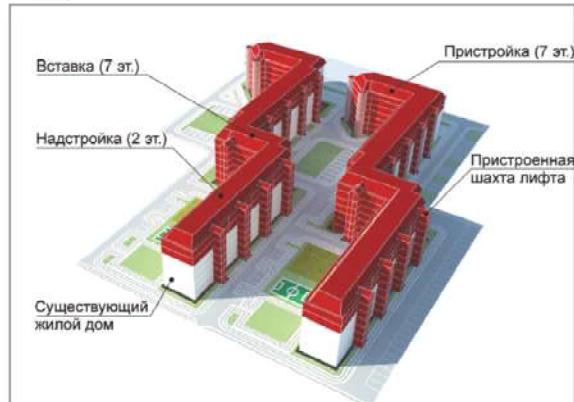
Реконструкция квартала без сноса жилых домов с отселением жителей:
